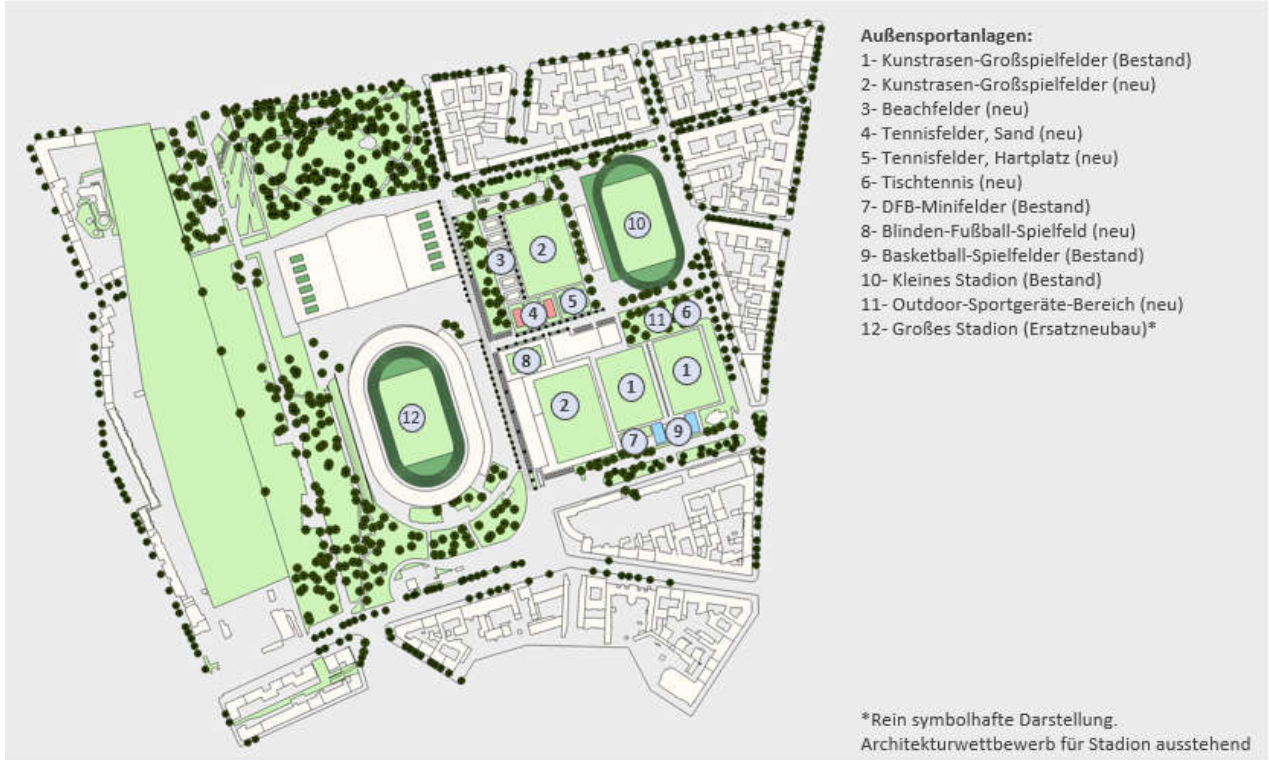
Lageplankonzeption Variante 3 – Außensportanlagen
